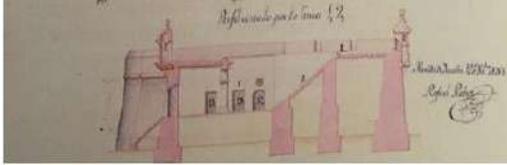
Plano Llobet. 1788 fuerte de sisal. fuente: Artonchiw
